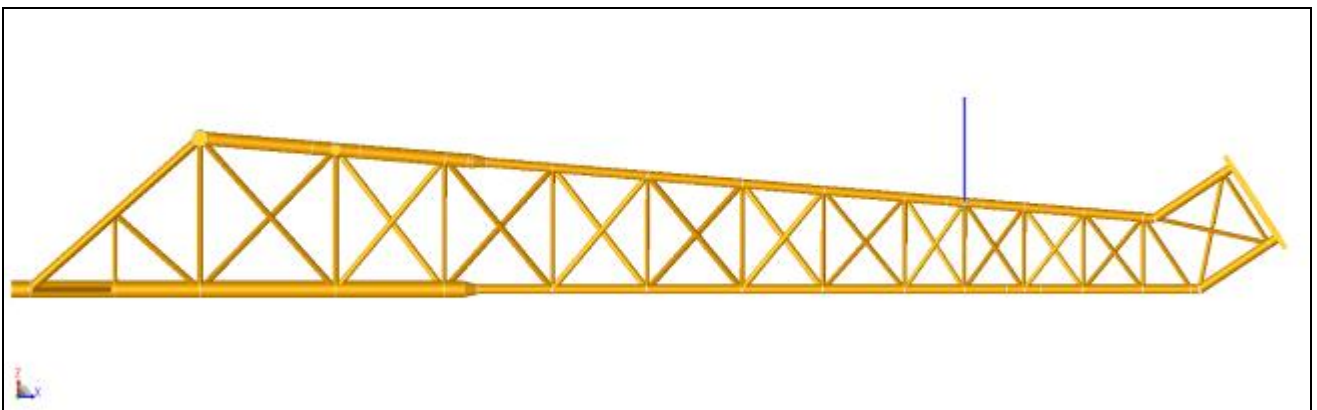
Fiaccola Modello Strutturale – Posizione Orizzontale Vista Laterale
